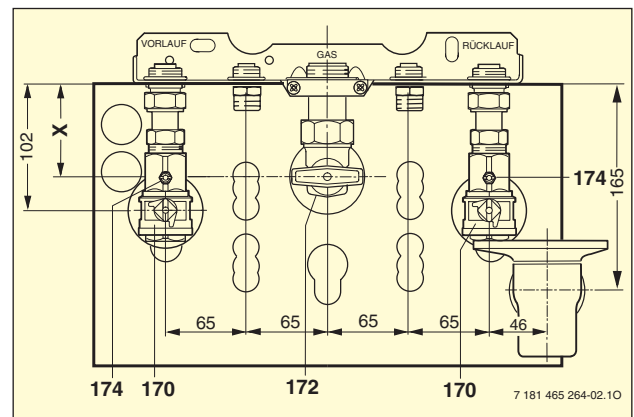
Montageanschlussplatte mit Unterputz-Installation (fertig montiert)
